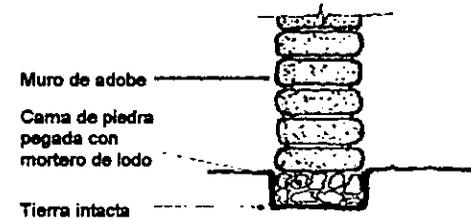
Cimentación a partir de piedras pegadas con lodo.
